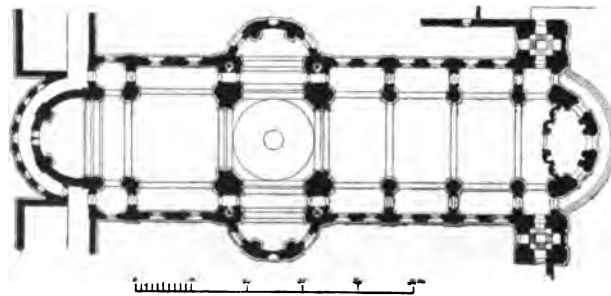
Grundriss der Klosterkirche zu Weingarten
